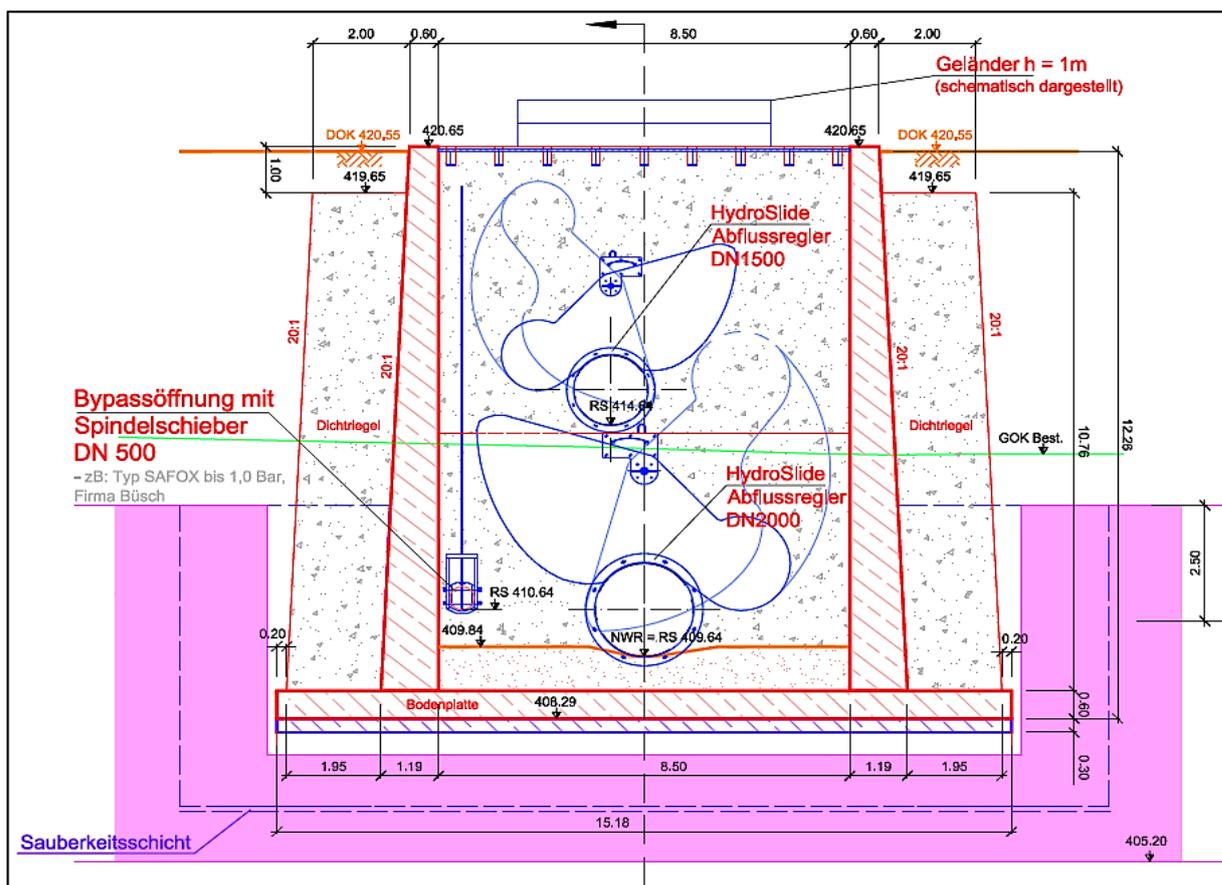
RHB Andritzbach / Planausschnitt Durchlassbauwerk [Q8]
